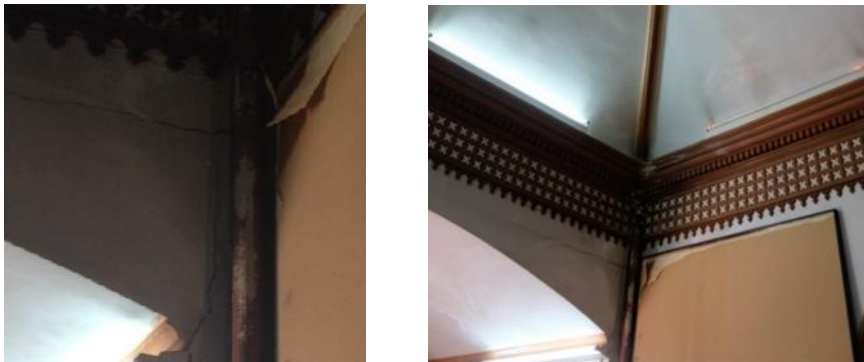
Unión de la zona central con la zona de acceso a la casa. Fuente: Propia.
